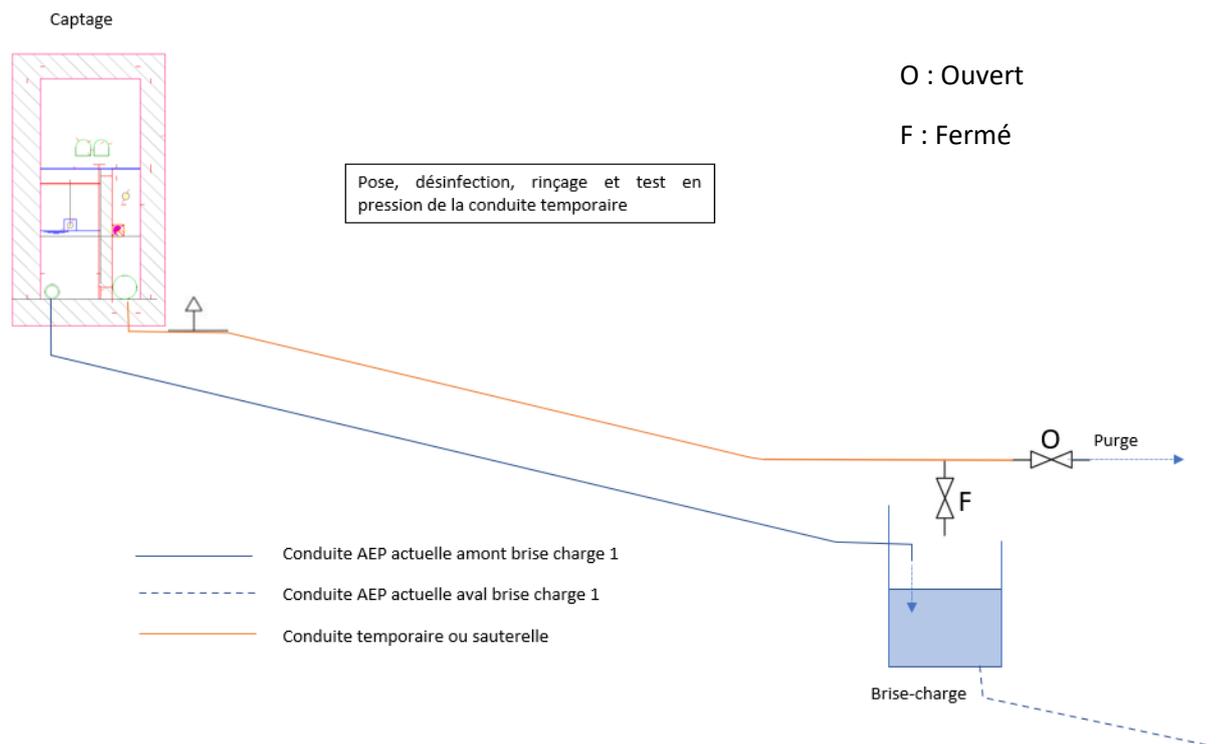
Pose, désinfection, rinçage et test de la conduite temporaire
